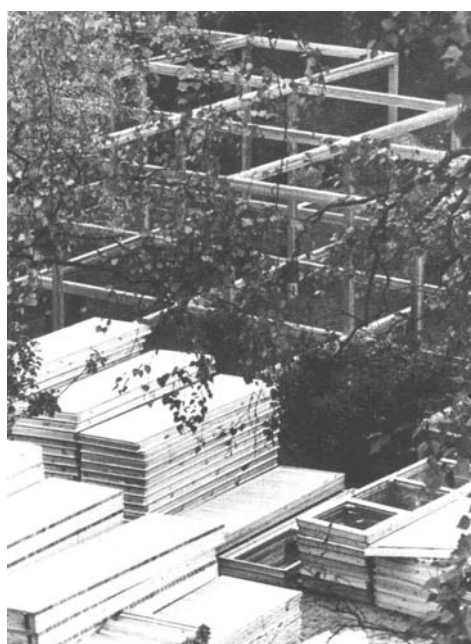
Construcción panelizada basada en la prefabricación de entrepisos, muros y cubiertas.
